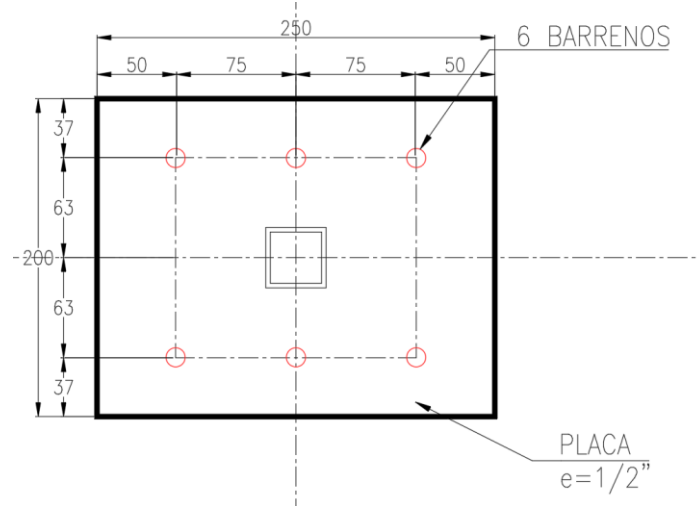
Arreglo de placa base para refuerzos en columnas perimetrales
